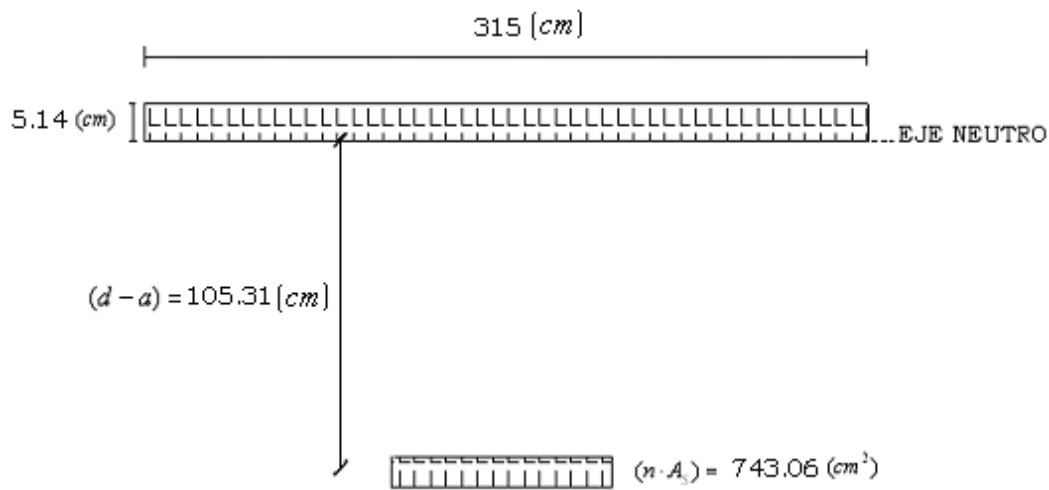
Sección fisurada de la viga exterior. Dimensiones en (cm).
